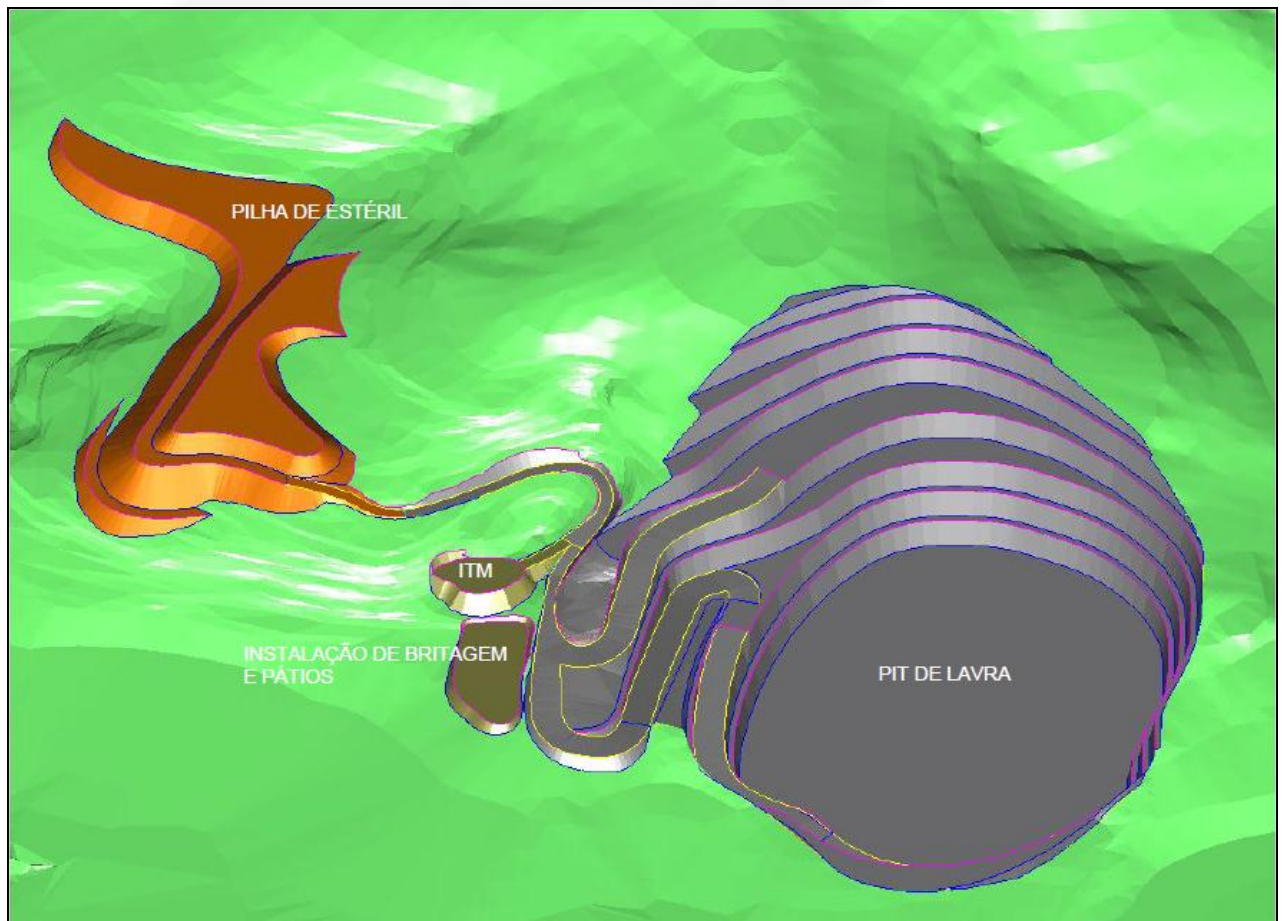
Vista em perspectiva da cava de lavra, pilha de estéril e UTM.
